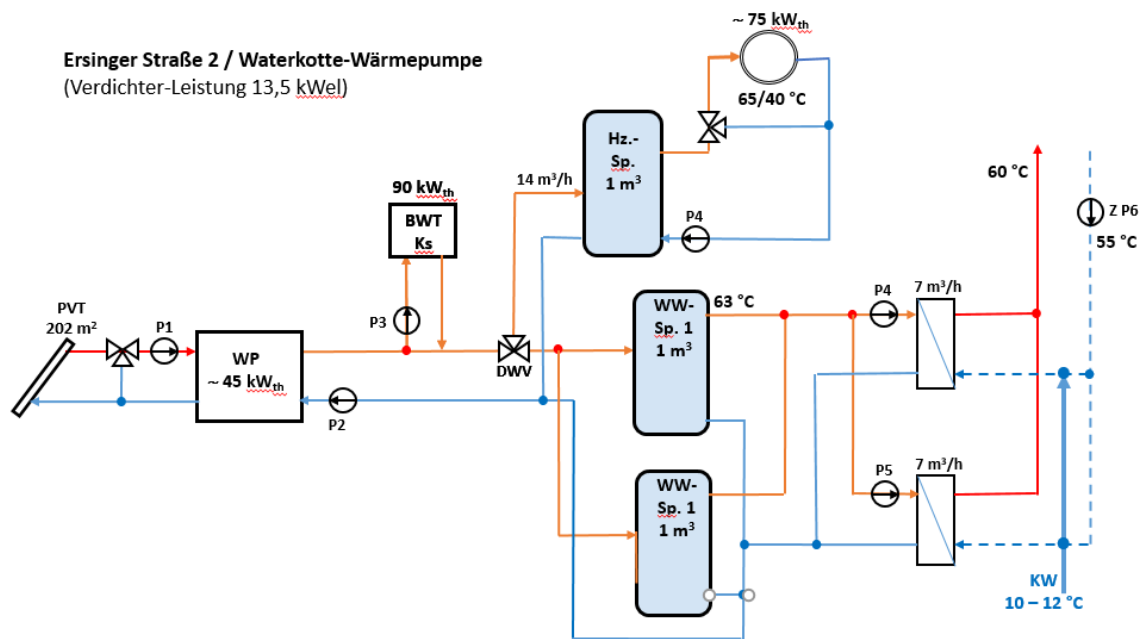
Vereinfachtes Hydraulik-Schaltbild der Waterkotte-Wärmepumpenanlage Ersinger Str. 2 mit Platzierung der Wärmemengenzähler.
